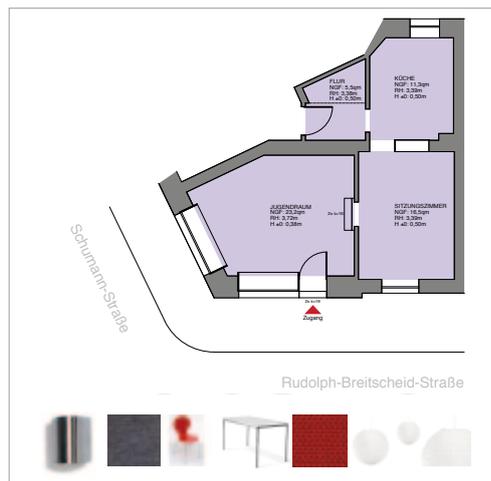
+ 7. Grundriss mit Bemusterung, Abbildungen per PDF aus Produktkatalog übernommen, Foto nach der Ausführung
